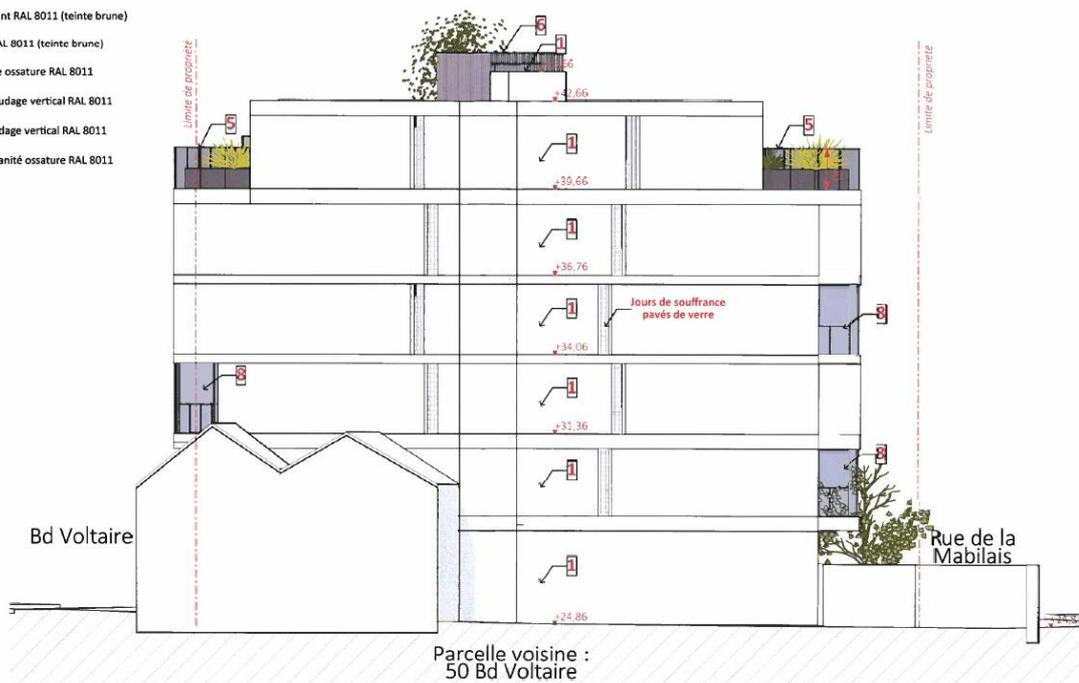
Façade Est au 14/06/2022 - © ALTA Architecture
